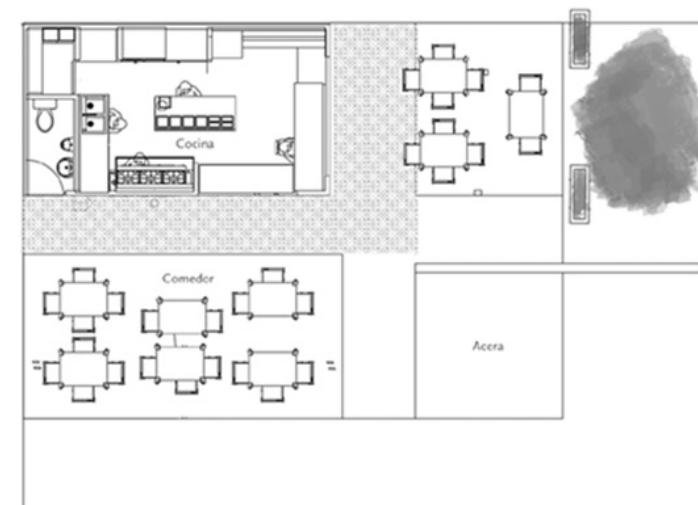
Planos Arquitectónicos del restaurante "La Pesca"
